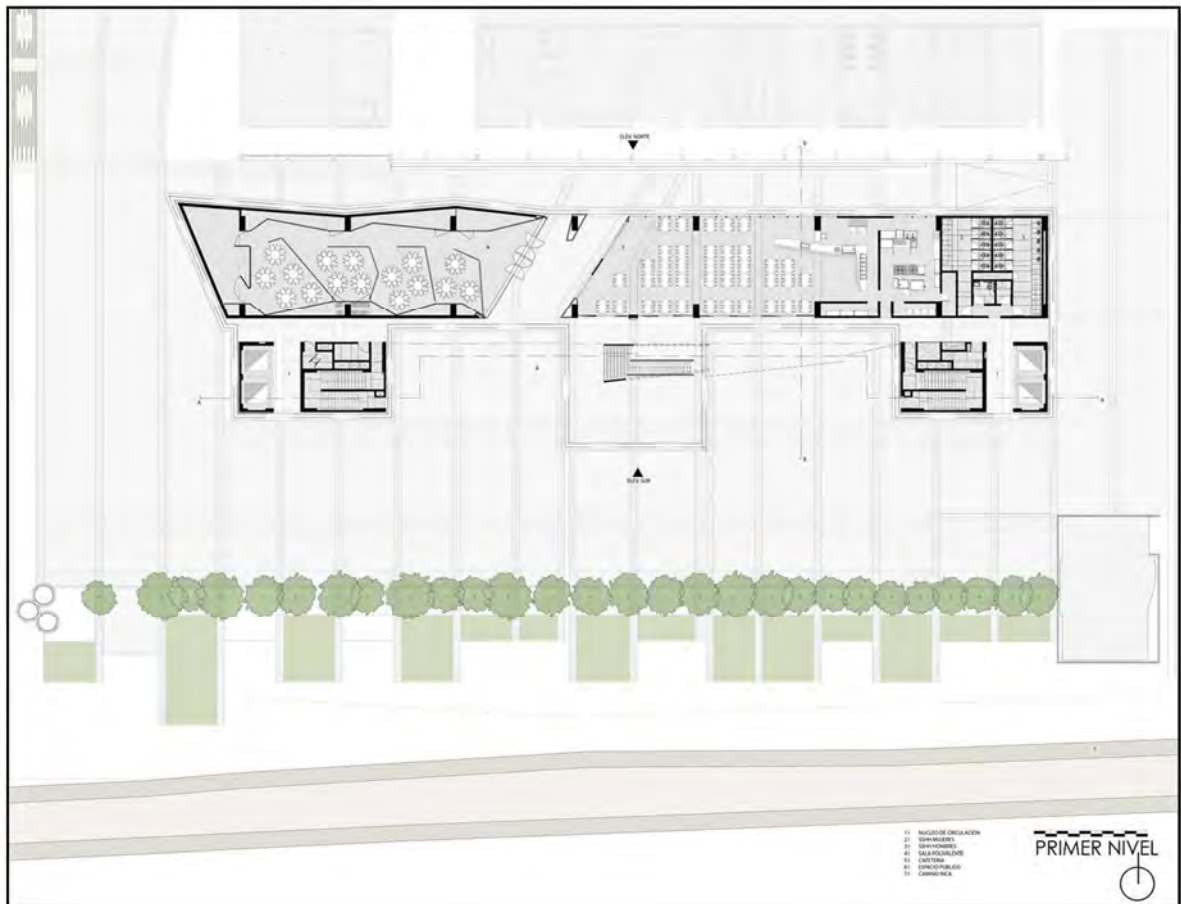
Vista de planta del Pabellón A (ingeniería). (Fuente: Archdaily.pe)
